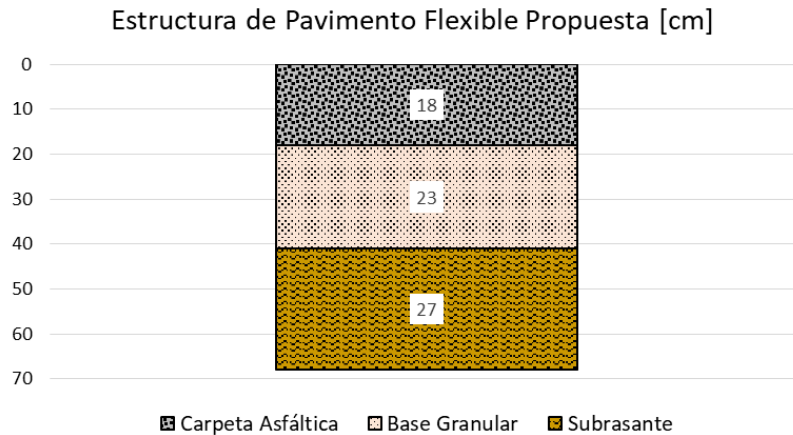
Estructura de Pavimento Flexible Propuesta
